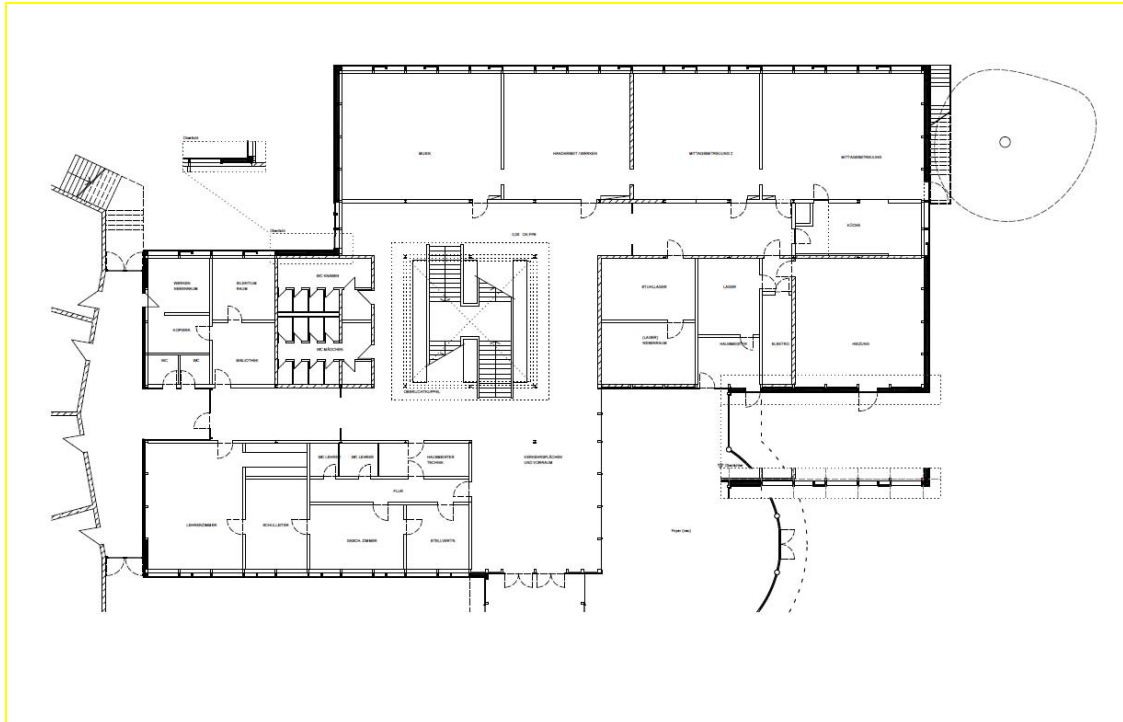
Schule Gundelfingen, Modernisierung Grundriss
